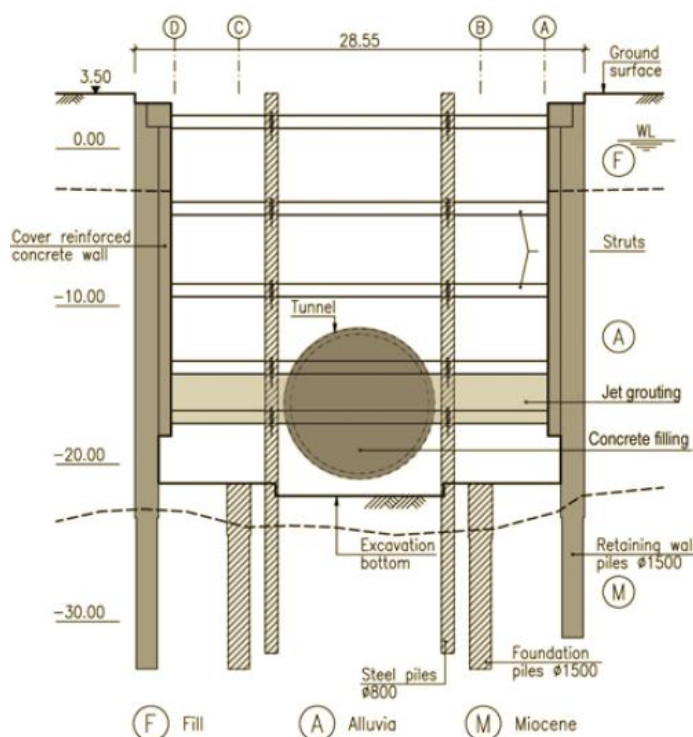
Corte transversal da escavação e da estrutura de retenção. (Matos Fernandes, 2010)
